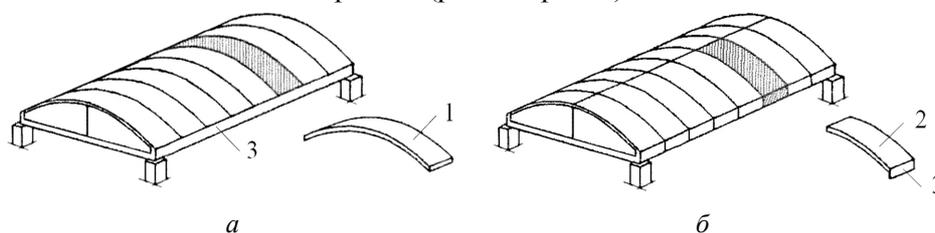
Схемы разрезки длинной цилиндрической оболочки на:
